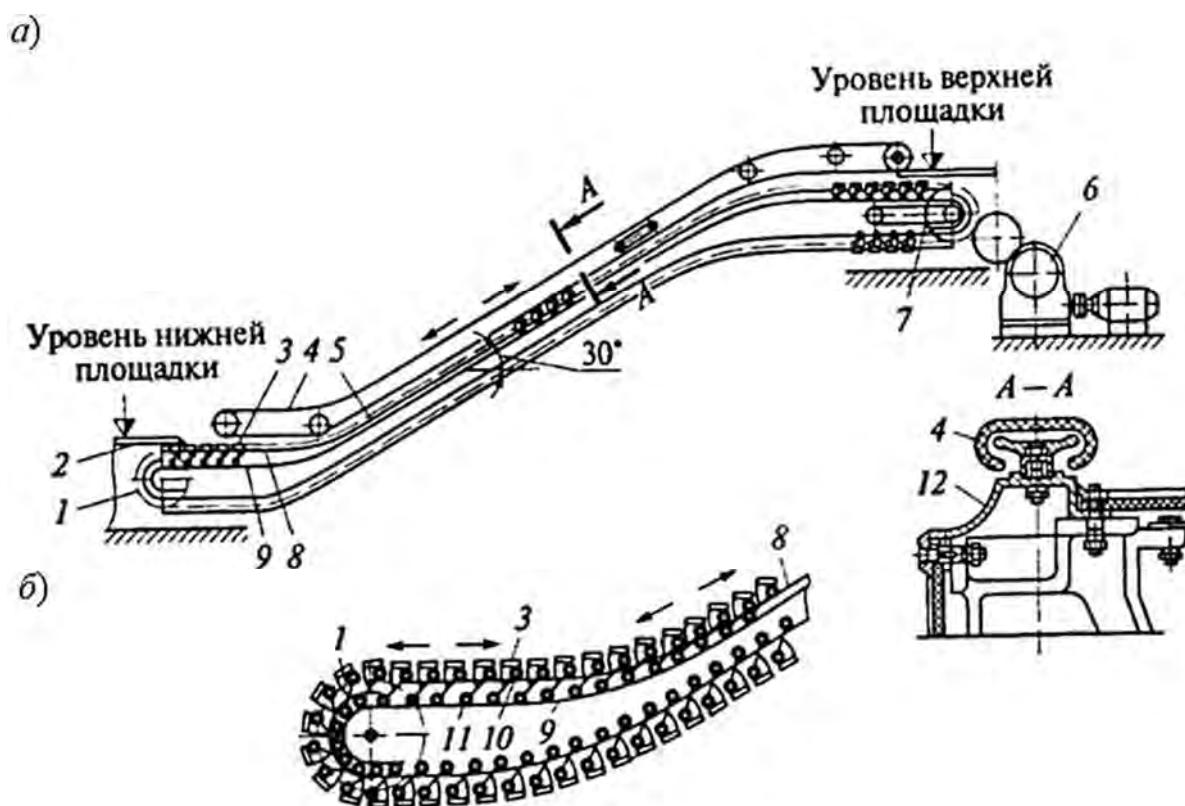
Эскалатор: а – кинематическая схема; б – схема прохождения ступеней по направляющим; 1 – натяжная звездочка; 2 – входная площадка; 3 – ступенчатый настил; 4 – поручневая установка; 5 – тяговая цепь; 6 – привод; 7 – приводная звездочка; 8, 9 – направляющие пути ведущей и холостой осей ступени соответственно; 10, 11 – колеса ведущей и холостой осей ступени; 12 – балюстрада
